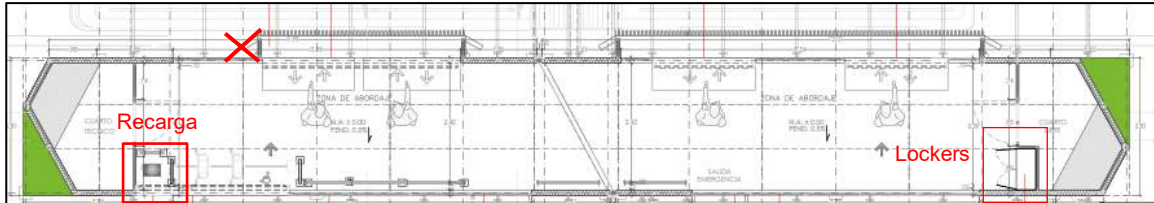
Corte en planta vagón. Inclusión zona de locker, espacio maquina recarga.
